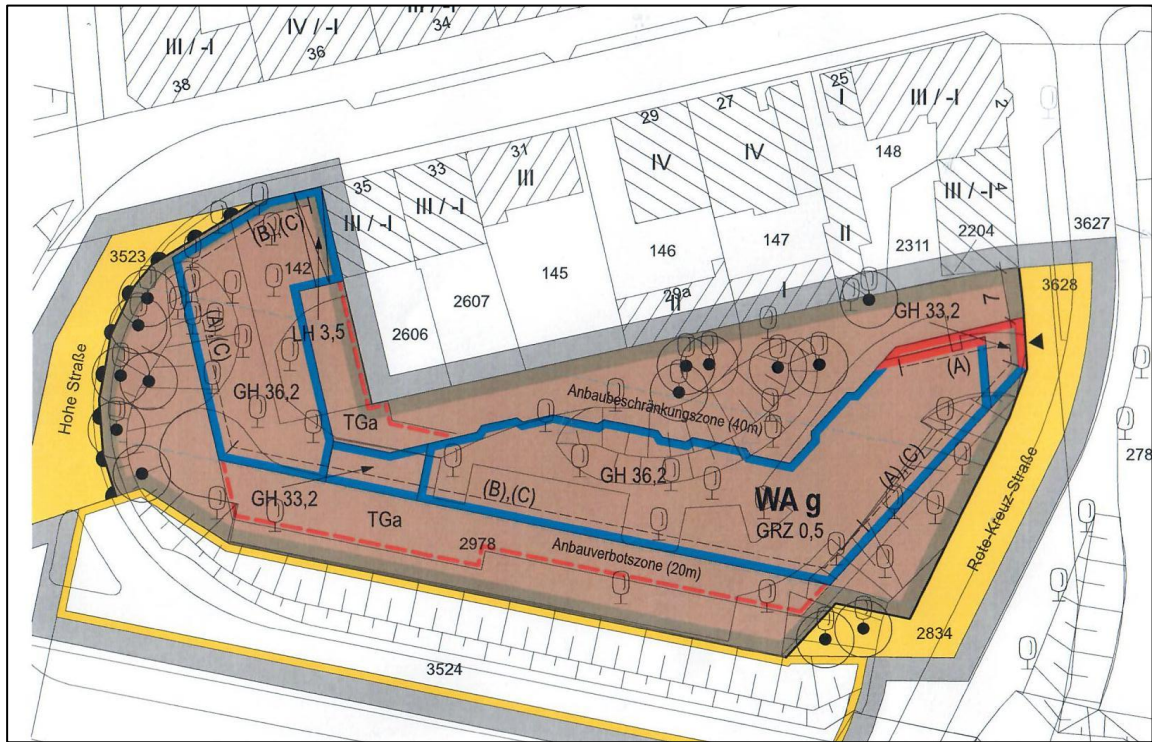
Bebauungsplan-Entwurf (Eingriffsbereich Flurstück 2978, Stand: 1.12.2023)
